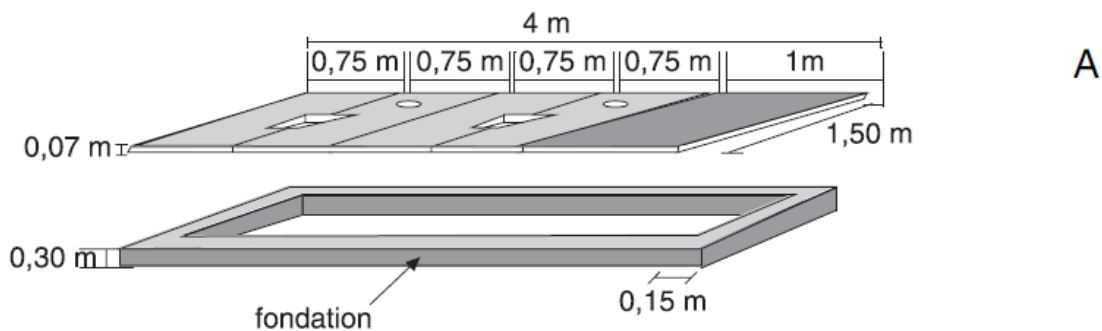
Fosse et fondations de toilettes à 2 postes. A : dalle sur fondation simple, fosse sans revêtement (ACF - 2006)
